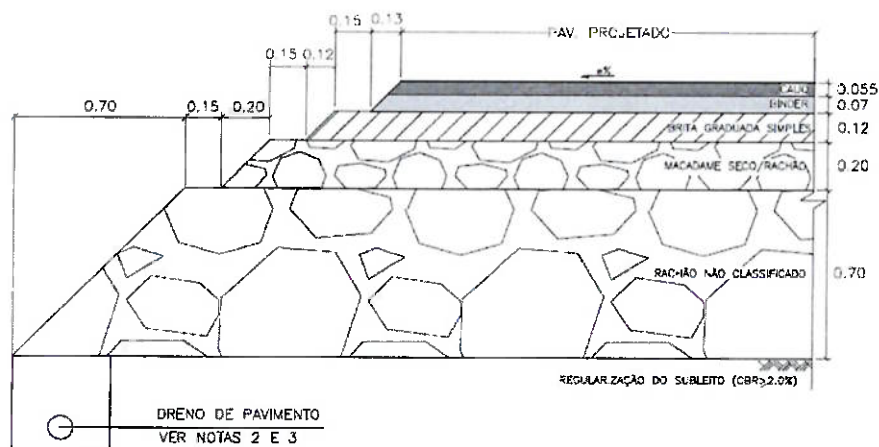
Desenho típico de uma estrutura de pavimento (Medidas em cm)
